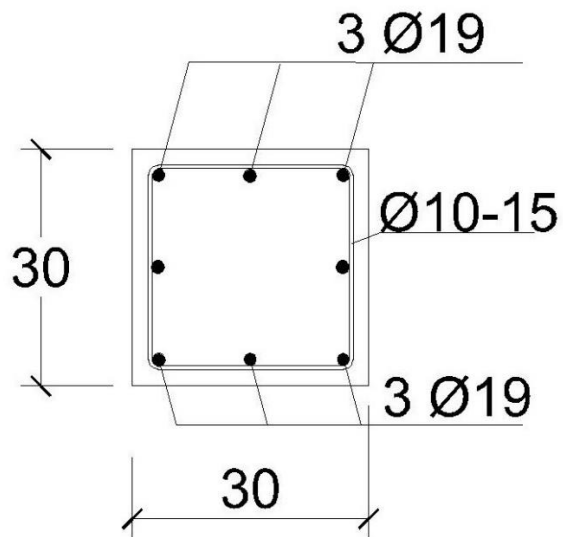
Denah Kolom Lantai 1 Sampai 5
